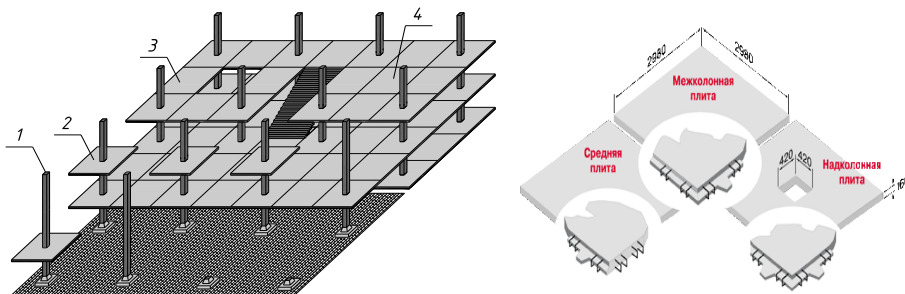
Схемы безкапитально-безбалочной конструктивной системы жилого здания: 1 – колонна; 2 – надколонная плита; 3 – межколонная плита; 4 – средняя плита
